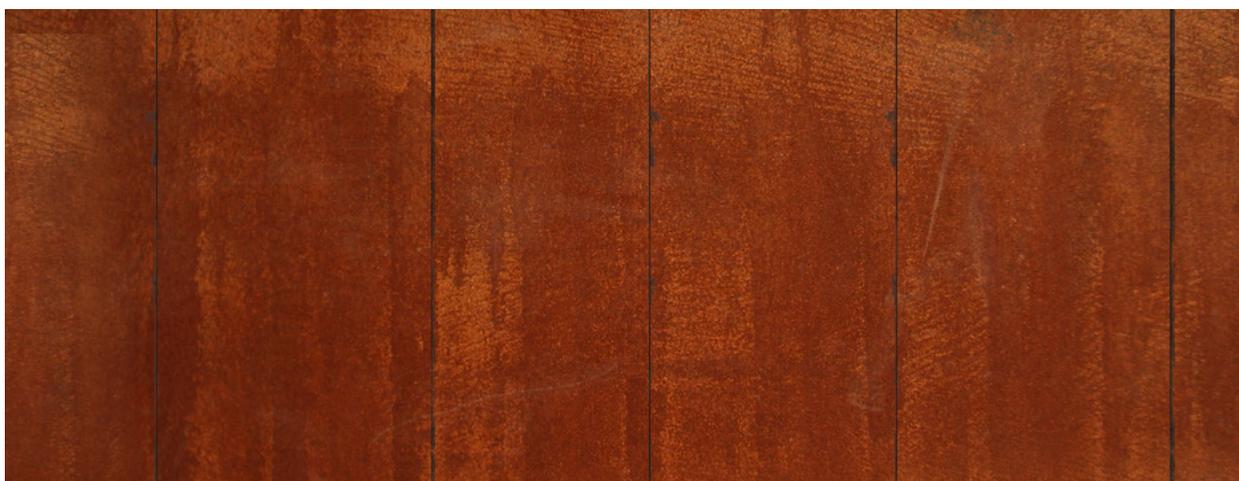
Aplicación acero corten. Edificio de Archivo Essener Geschichte + Puente Can Gili + Museo Celtico. Glauburg, Alemania
